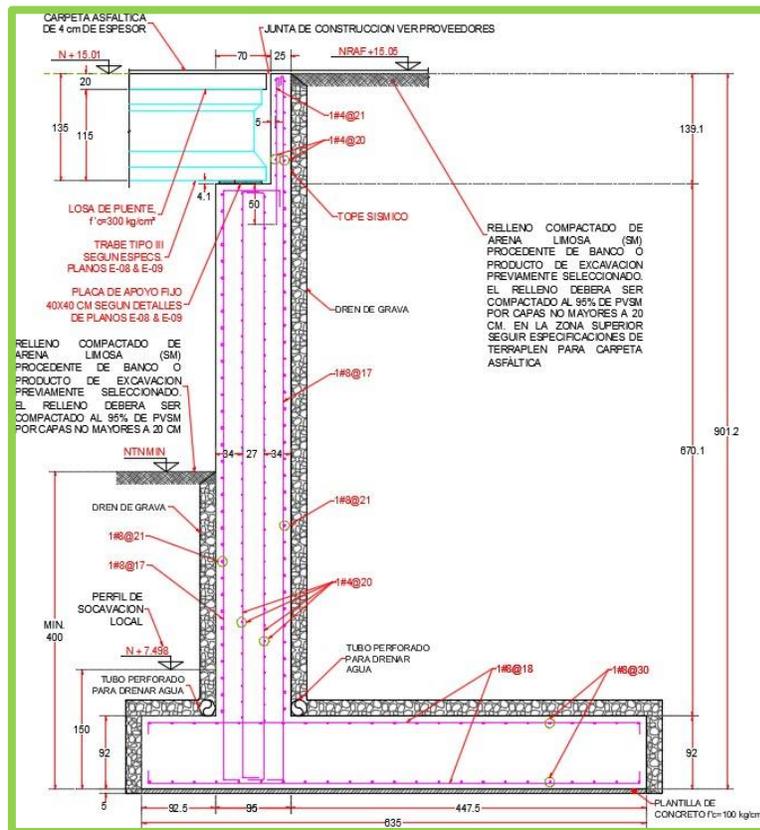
Sección transversal de estribo sur, donde se ilustra el armado de refuerzo.
